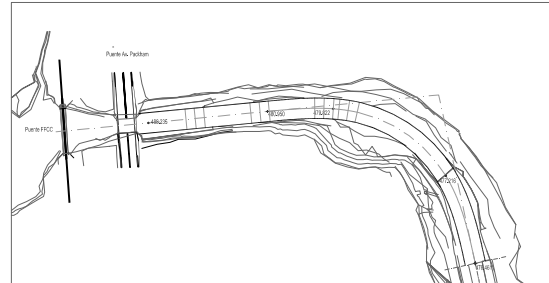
Plano en planta de la obra analizada en la etapa de diagnóstico
